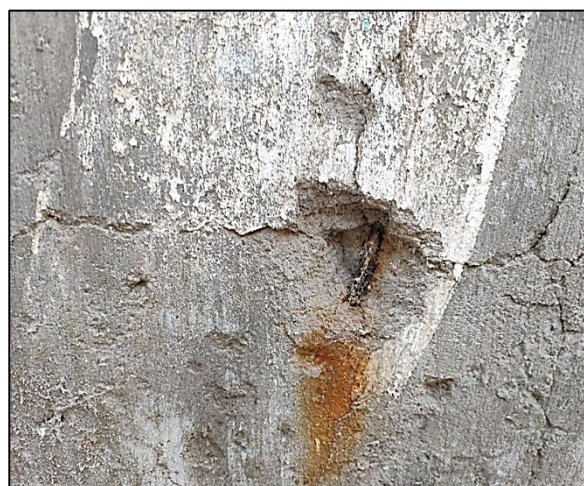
Presencia de picaduras en la estructura de concreto. Fuente: Elaboración propia.
